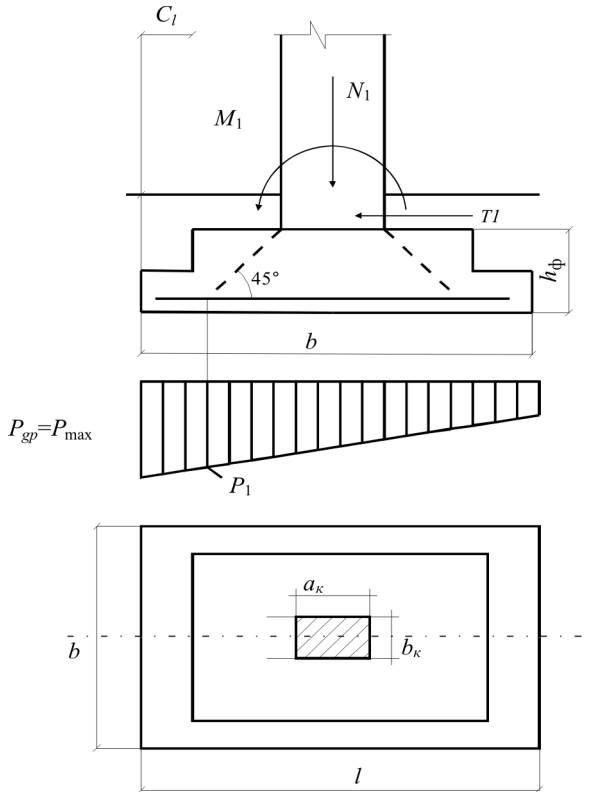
Схема до розрахунку фундаменту на вигин
